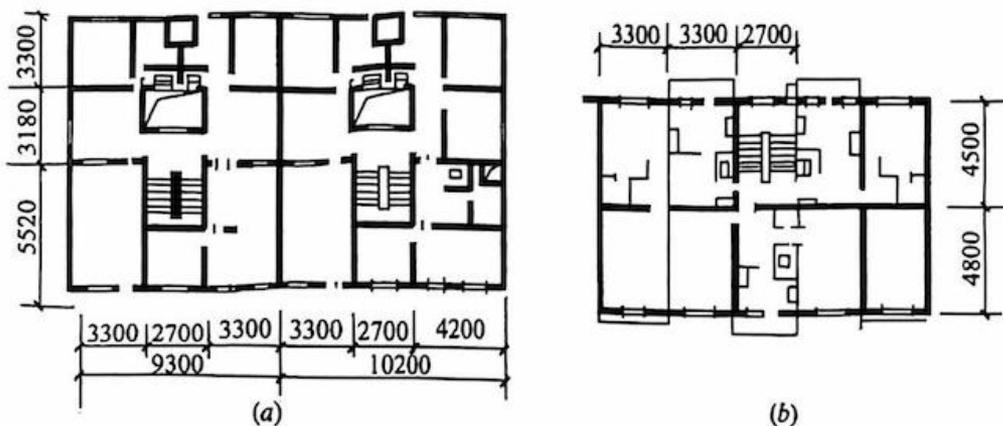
大进深、小面宽 (a) 和小进深、大面宽 (b) 住宅平面图
